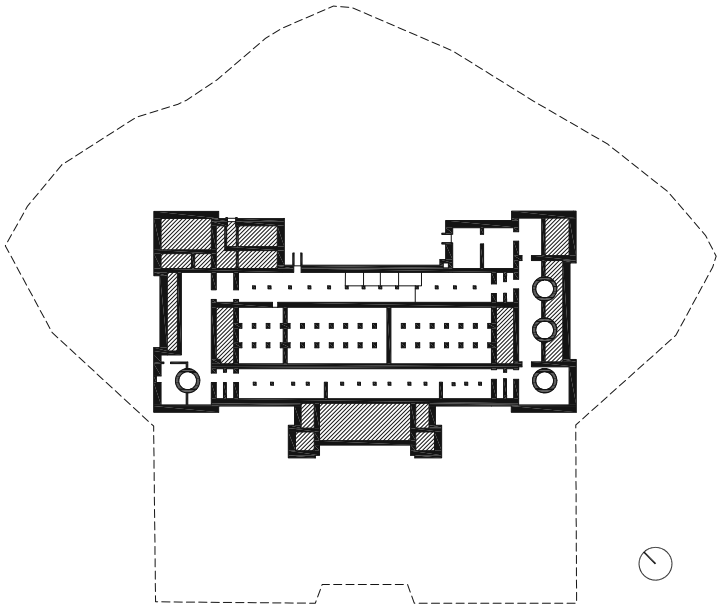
Rekonstruktionsmodell: Horizontalschnitt Kellergeschoss | Bestand vor BVA
